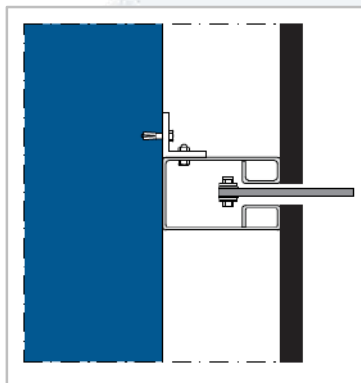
Монтаж на управляваща конструкция под хоризонтална стена/конструкция с декоративен елемент
